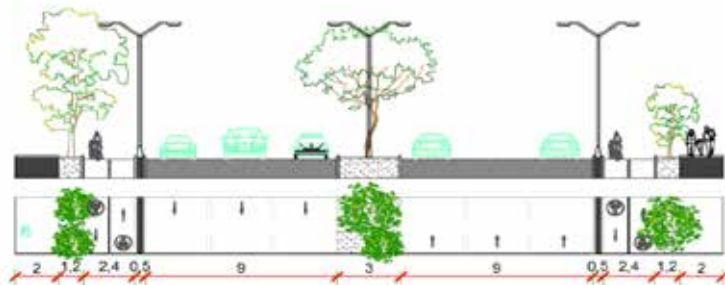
Perfil vial carretera Nacional. Fuente: Propia AutoCad (2019)
